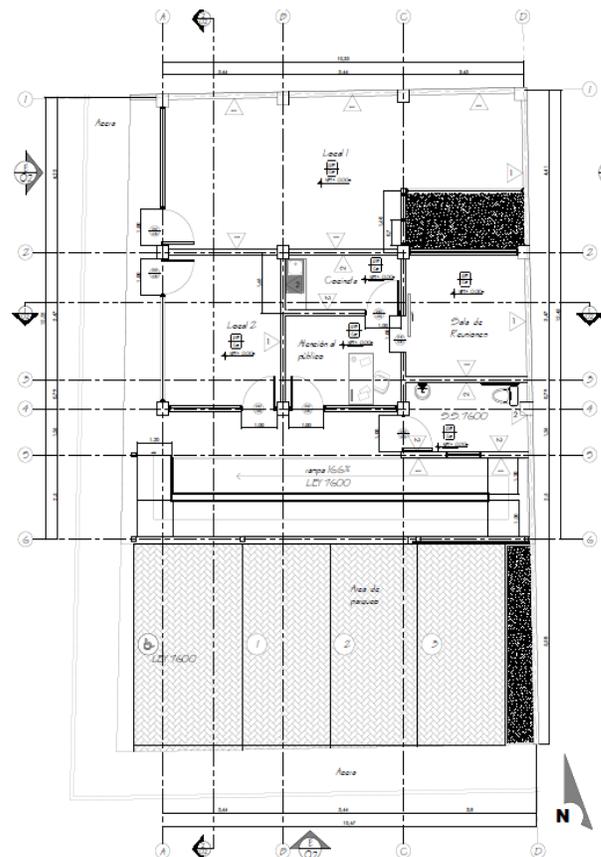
Planta de Distribución Arquitectónica primer nivel UCADEA
